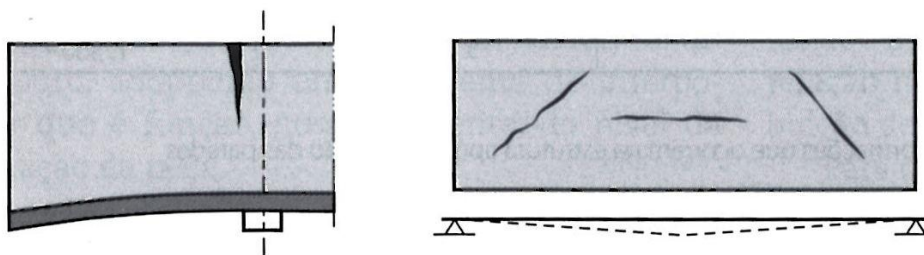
Deformação excessiva da estrutura causando fendilhação em elementos não estruturais [4]
